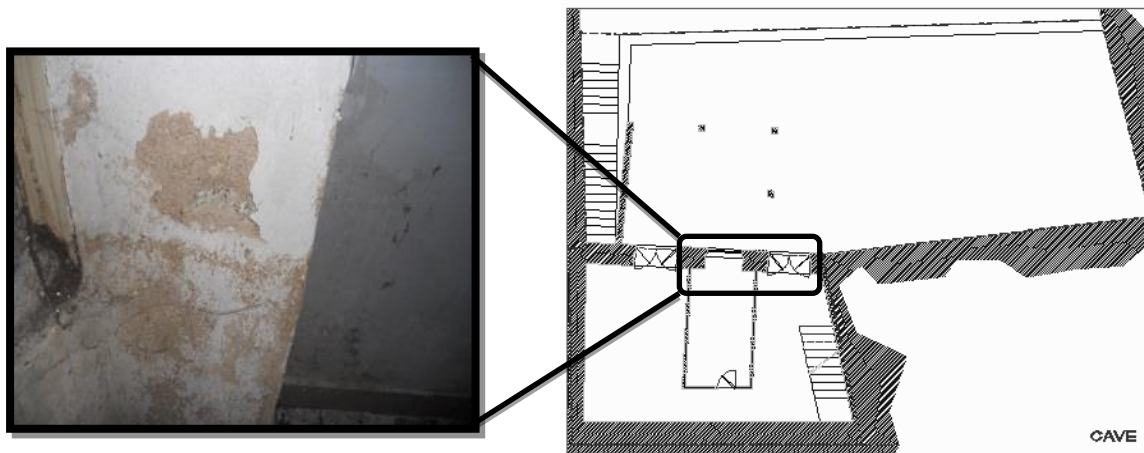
Anomalia 1 - Fotografia e localização em planta.
